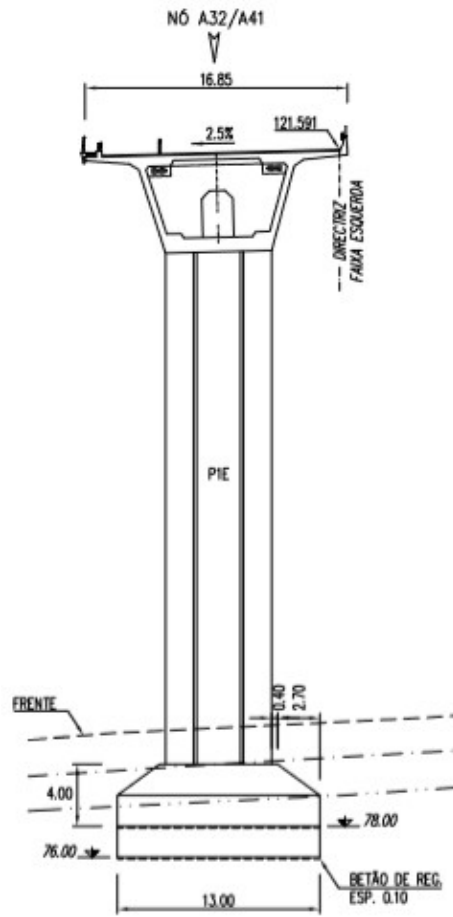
Dimensionamento dos pilares do viaduto do Covelo. (Rito, Armando. Projecto de Execução do Viaduto do Covelo, 2008)
